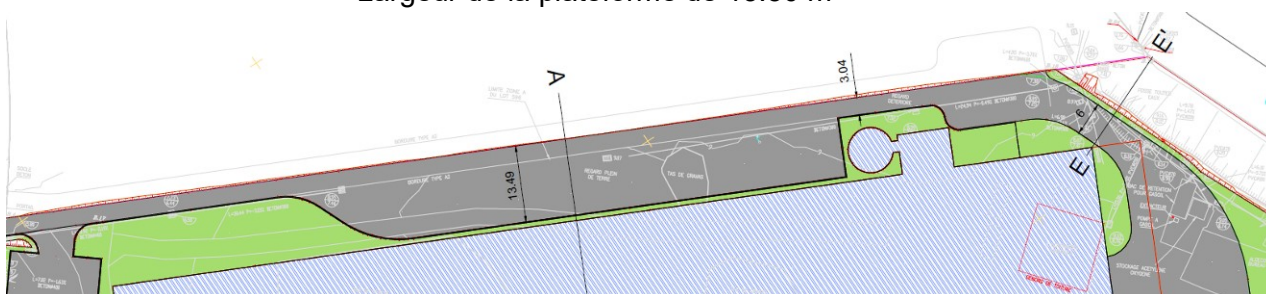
Vue en plan : voie de sortie Poids Lourds (Nord)
